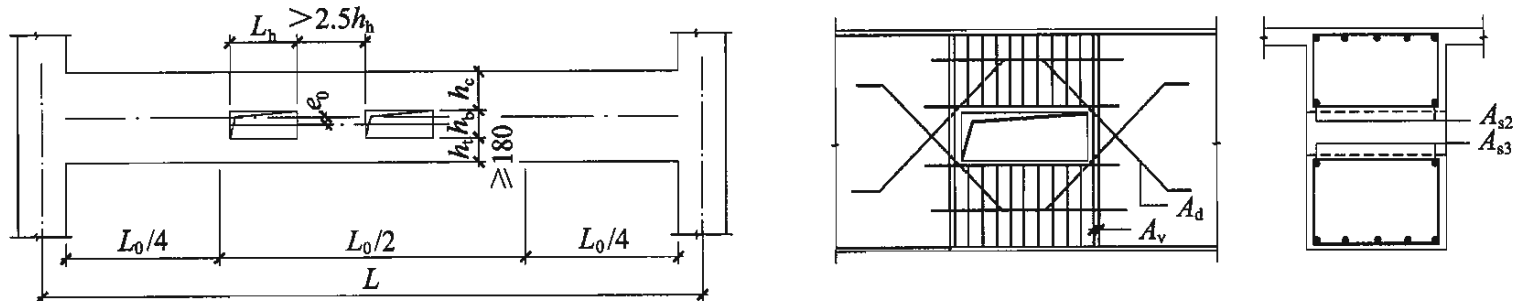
预应力梁上开矩形孔及加强构造
